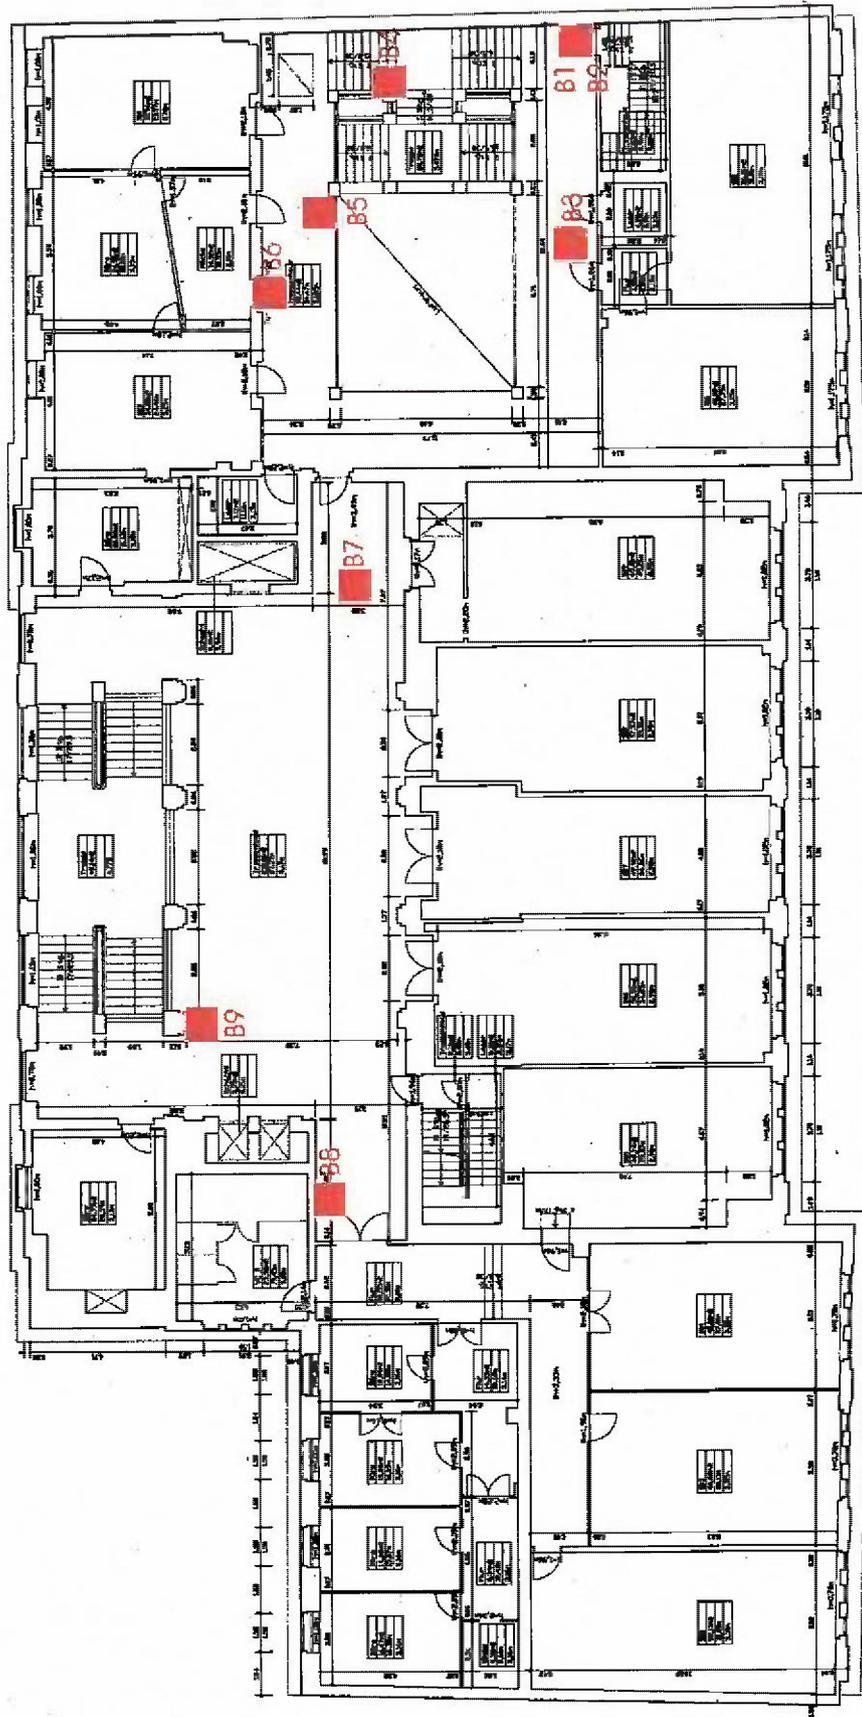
Haupthaus, Erdgeschoss Brunnen
